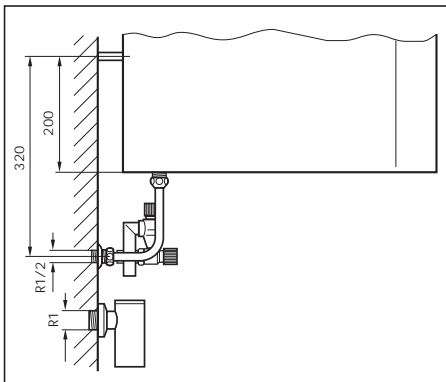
Seitenansicht bei geschlossenem System (Maße in mm)
